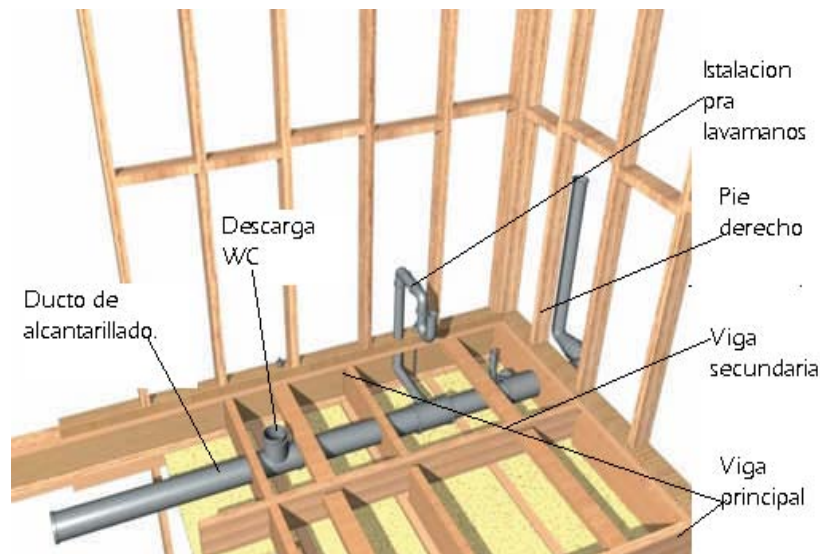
Colocación de cañerías paralelas a las vigas principales y pies derechos.
